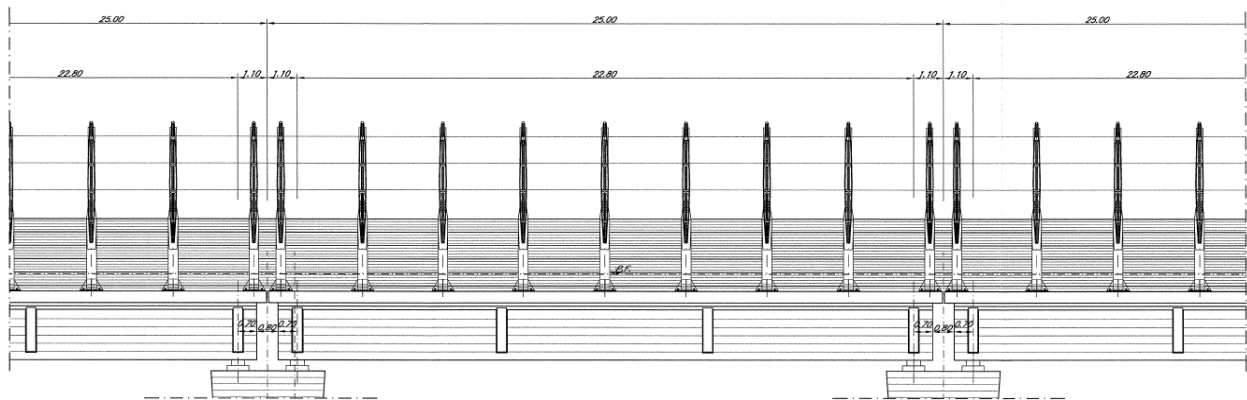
Prospetto tipo viadotto c.a.p. L=25.00m
